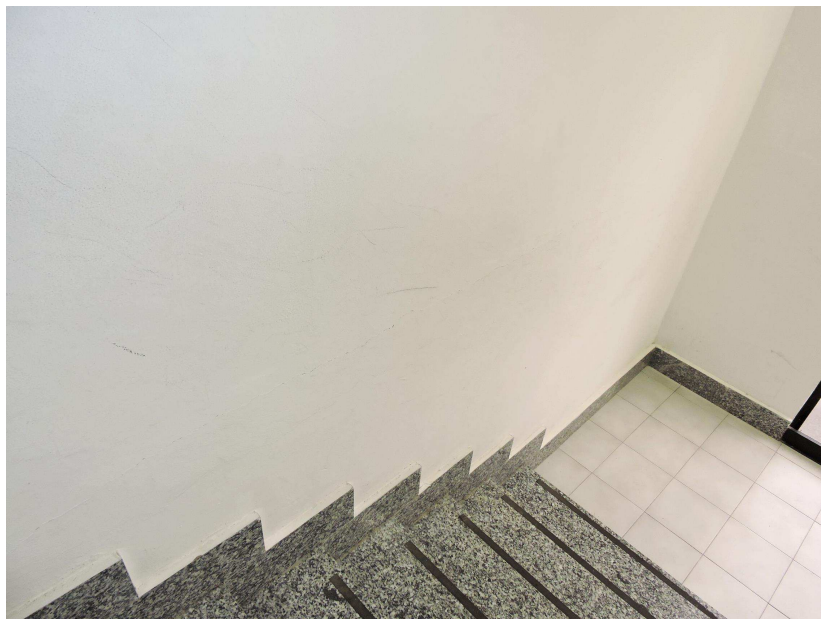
Cavillatura superficiale dell'intonaco nel vano scale, presente in tutti i piani sul lato N-E e S-O.
